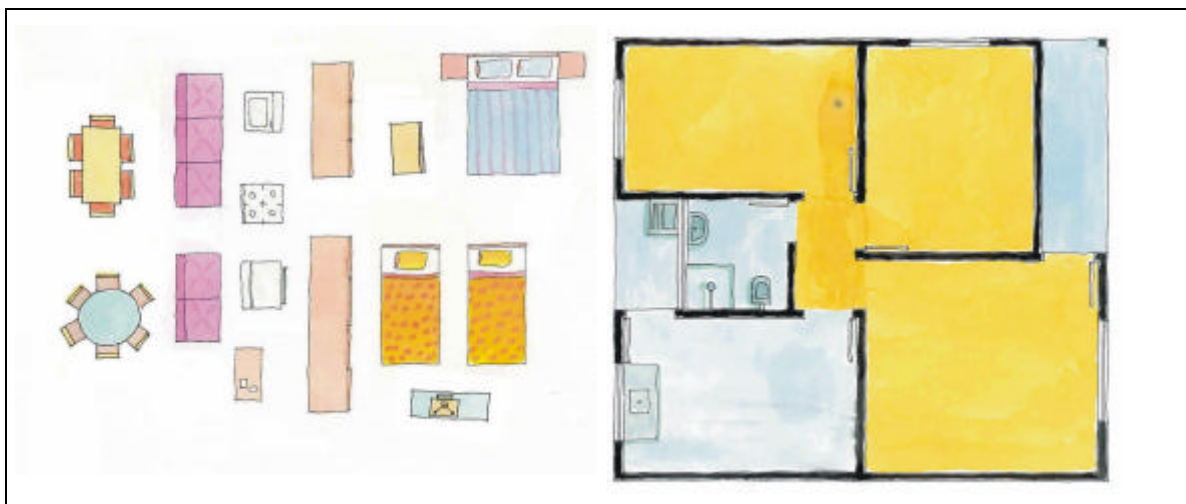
Planta genérica de uma casa e móveis para recortar e fazer o exercício de layout
